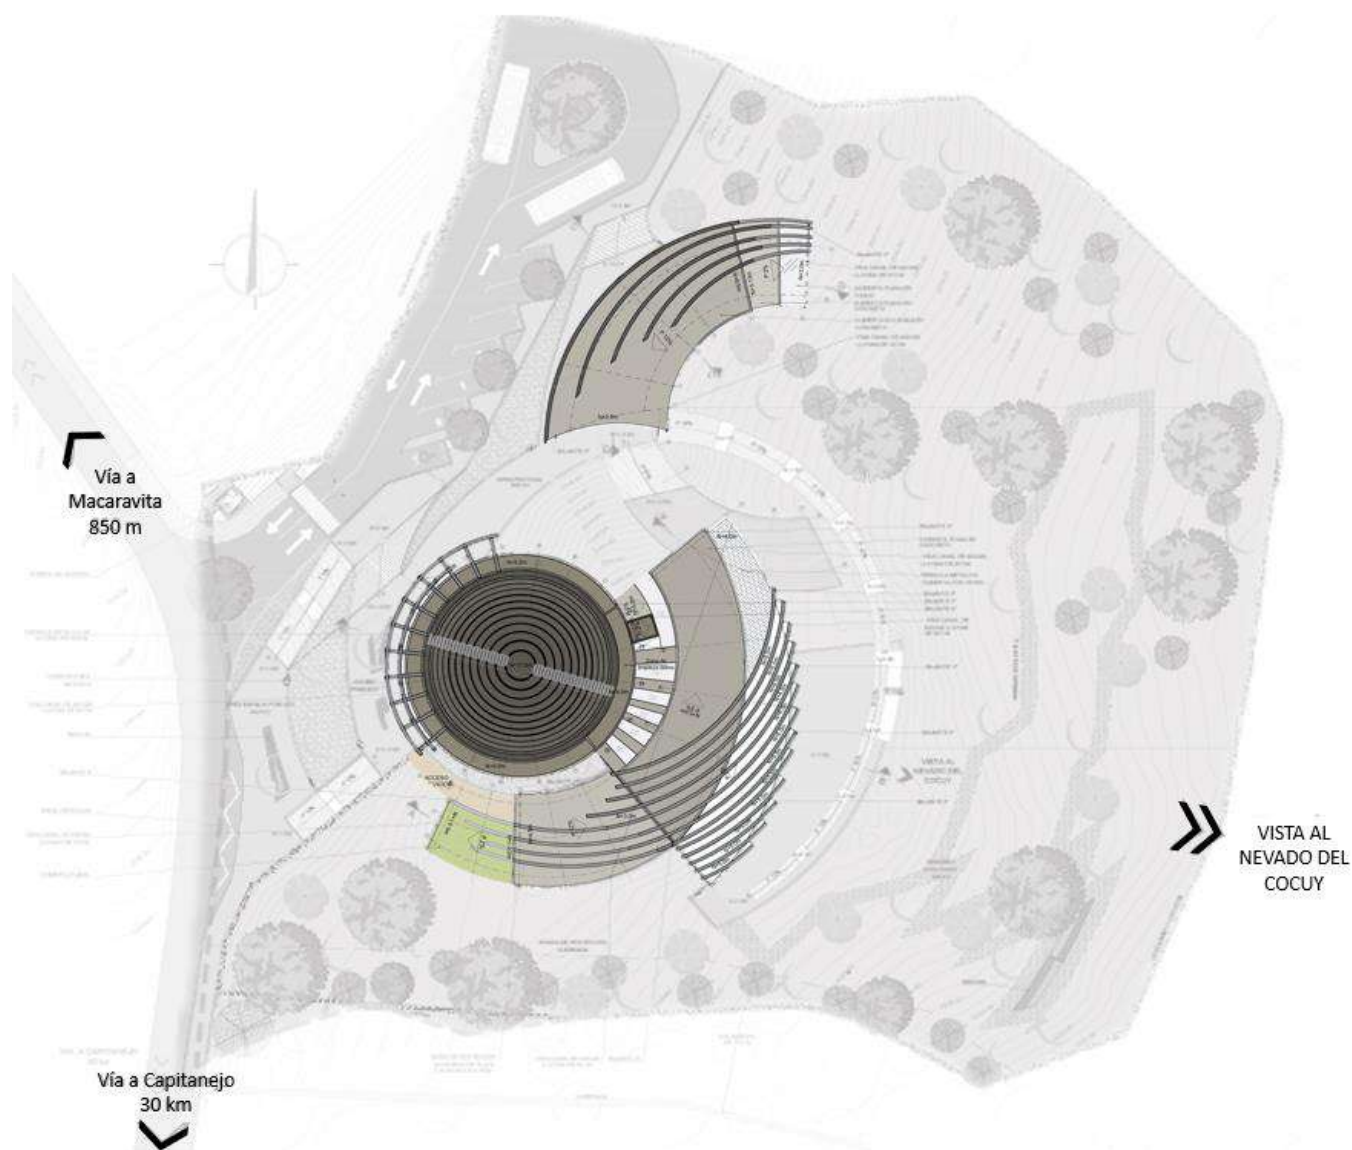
Planta general nivel +/- 0.0m edificio norte zona de habitaciones
